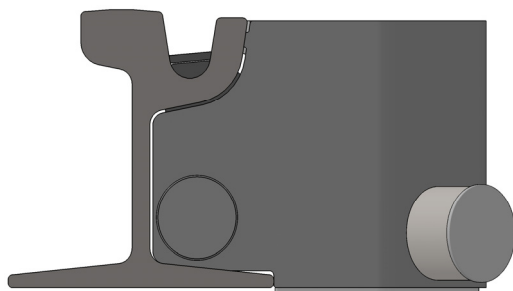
Type SK420-008 (Schienenprofile Ri59N, Ri60, Ri60N; geschweißt)
